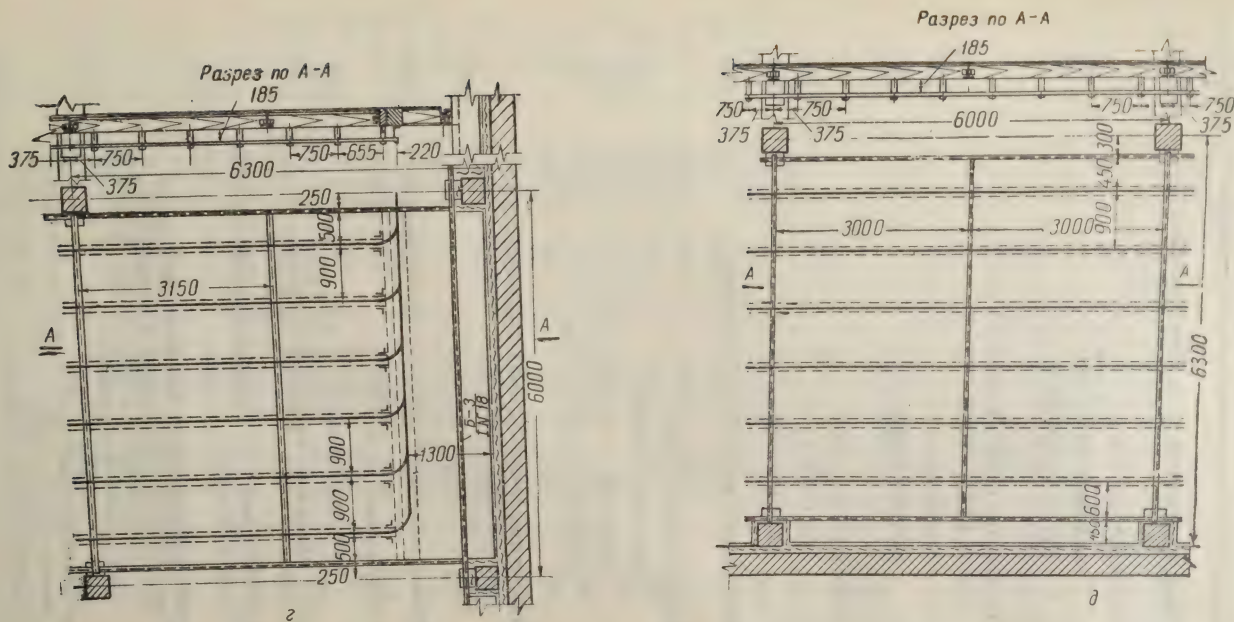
Схема расположения каркасов подвесных путей на холодильнике:
